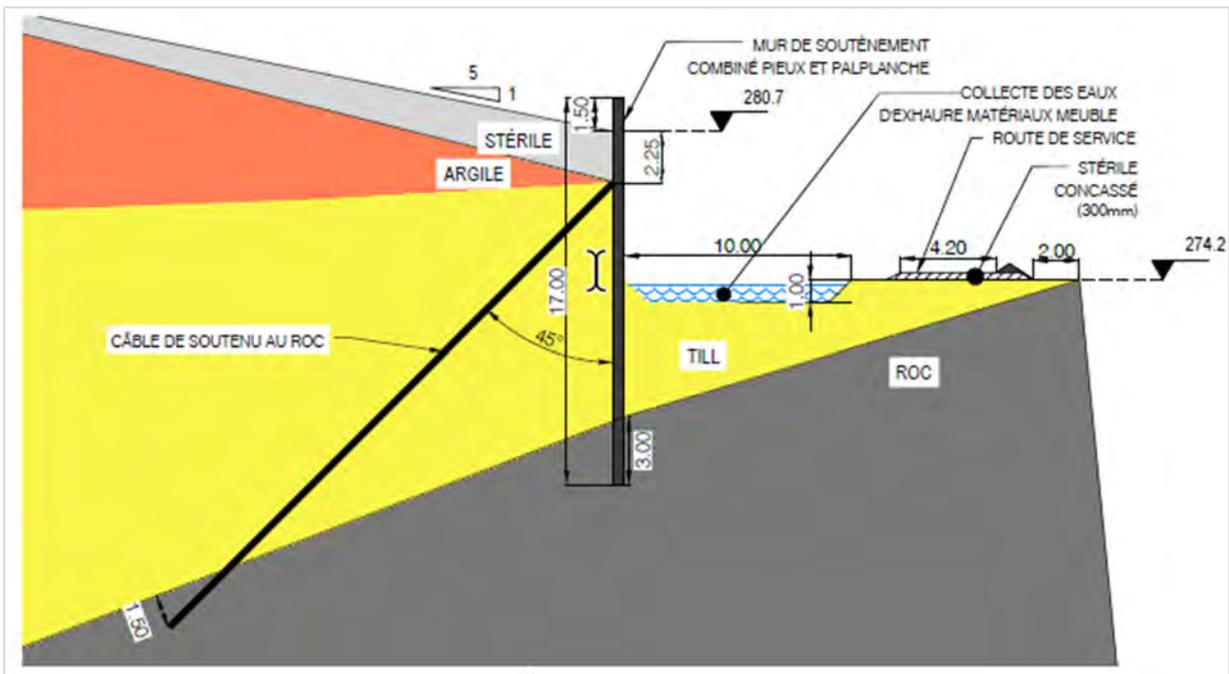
Vue en coupe - Mur combiné de pieux et de palplanches
